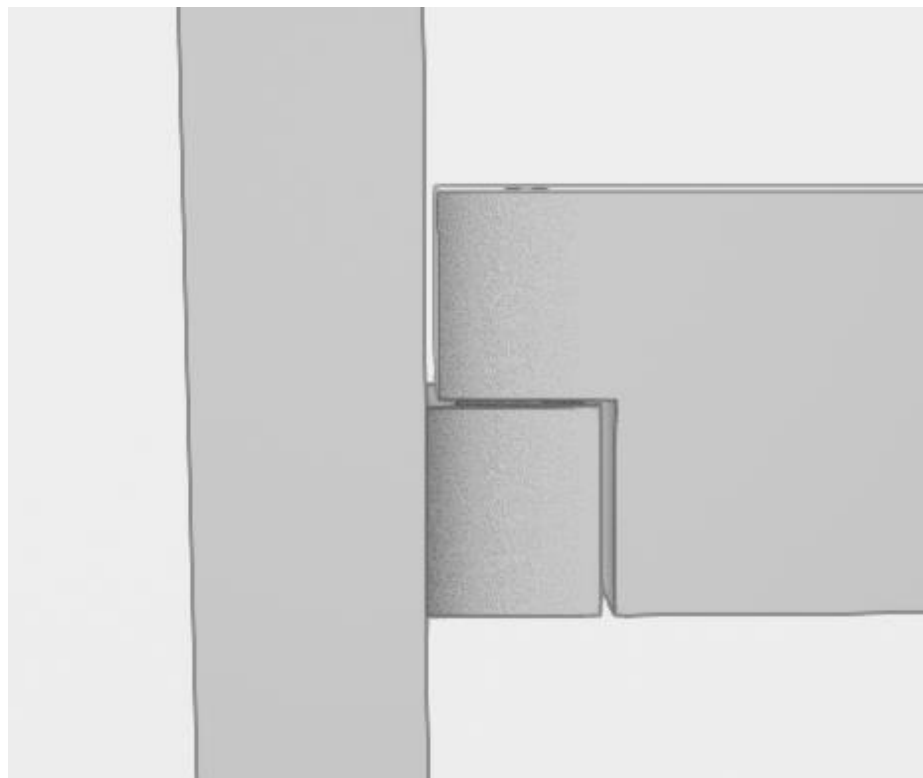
Viga pré-fabricada de concreto com dente gerber
